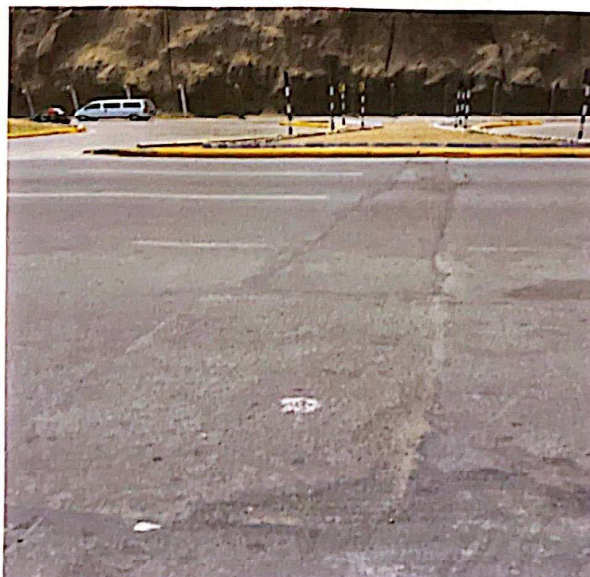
Sector 5.- Pavimento erosionado en la carretera lado Este
